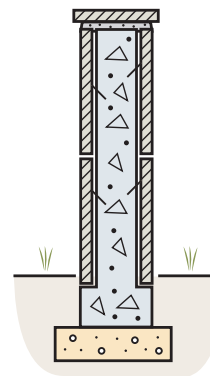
Frittstående mur med plater faststøpt i betong med holdekramper i rustfritt stål.
